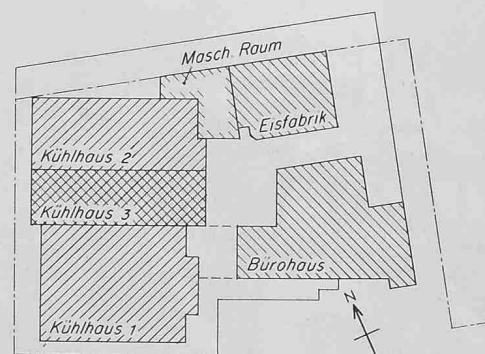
Lageplan 1:1500 der Kühlhäuser 1, 2 und 3 mit Maschinenraum, Eisfabrik und Bürogebäude
